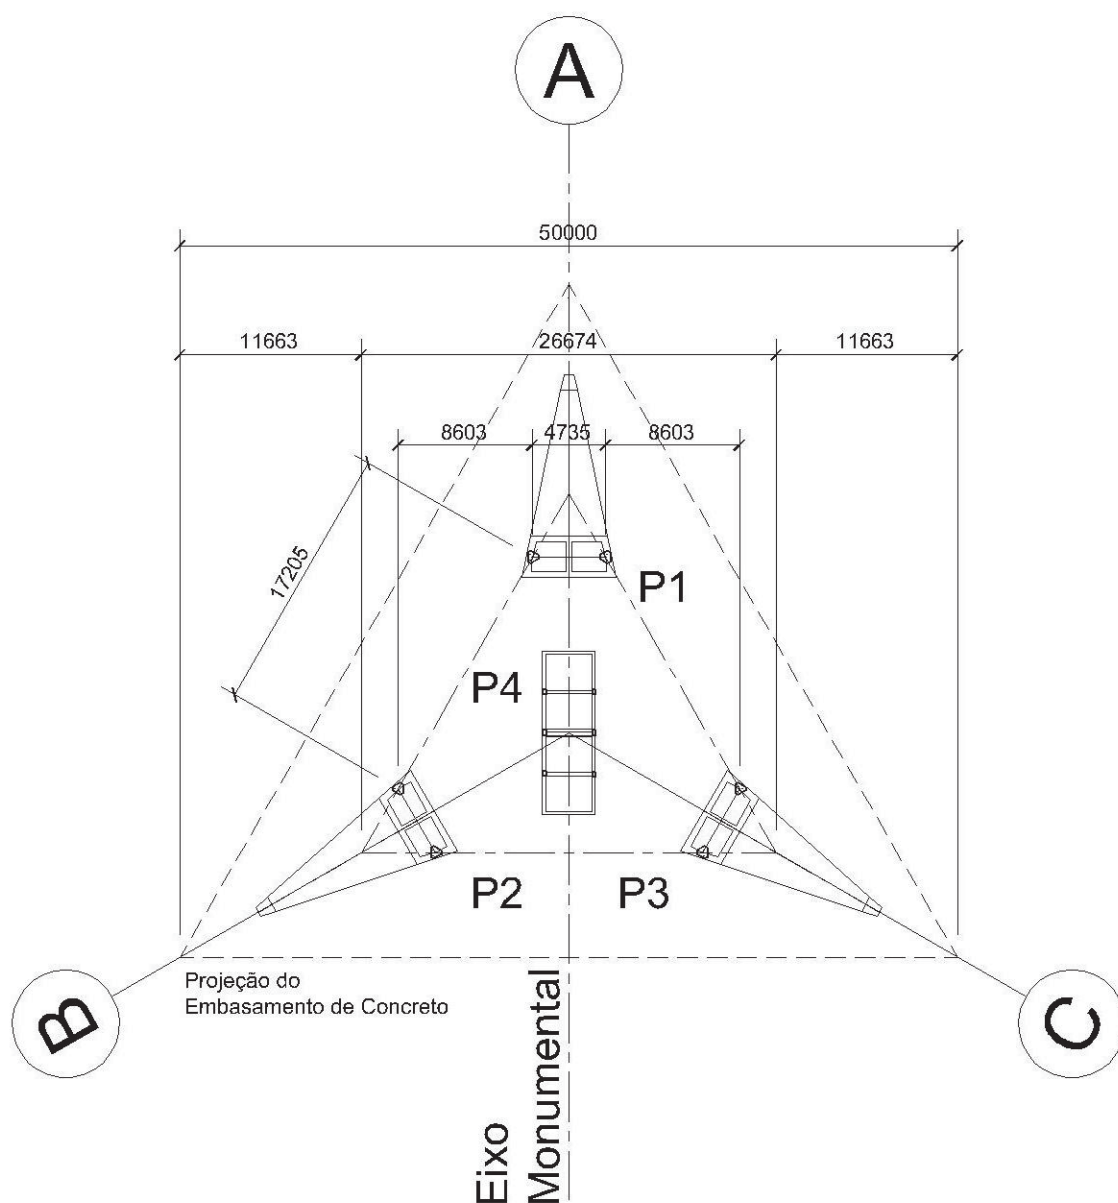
Locação da Estrutura Metálica (Fonte: Autor - Cotas em “mm”)
